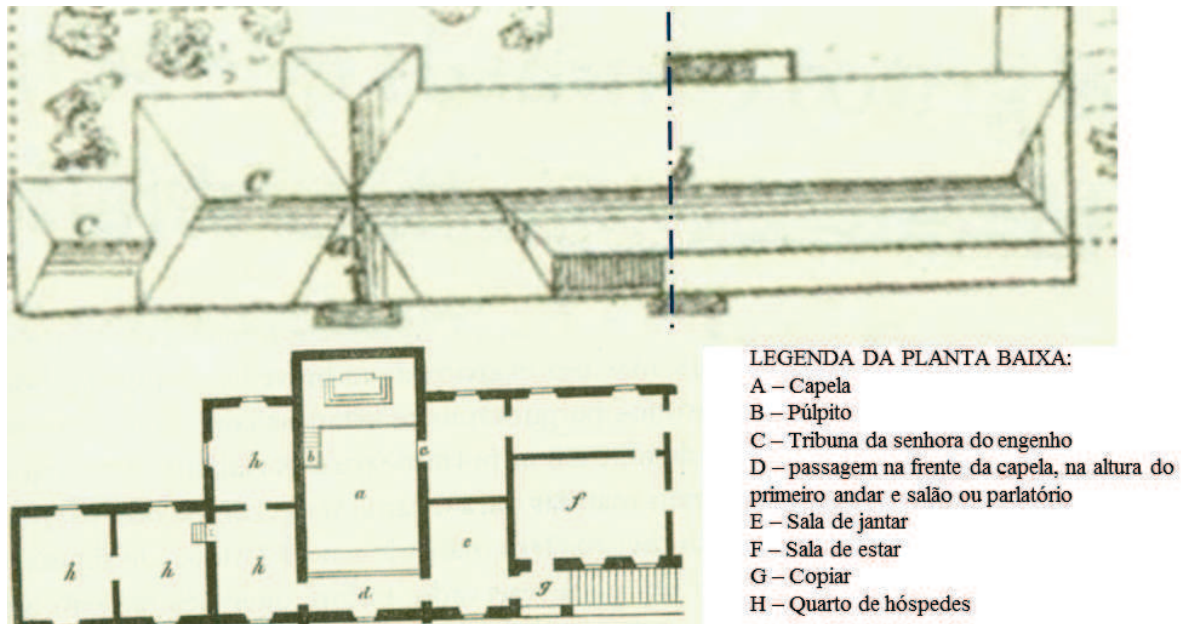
Planta de cobertura e planta baixa da casa-grande de um engenho.
